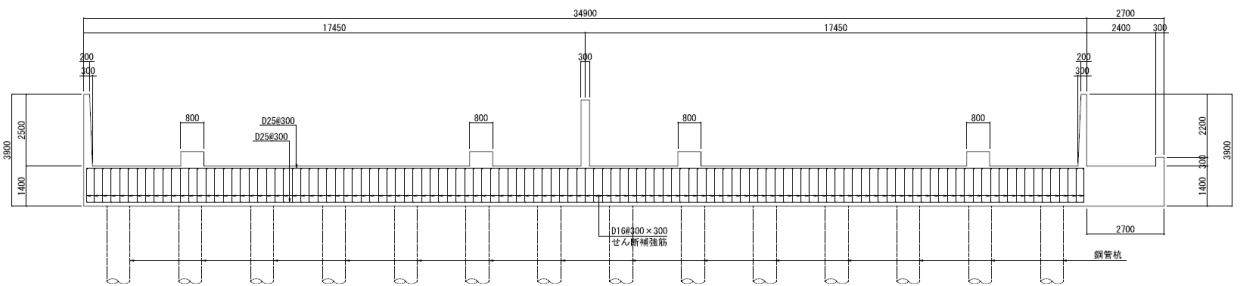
(2) 軽油タンク基礎の概略配筋図 (B-B 断面)
